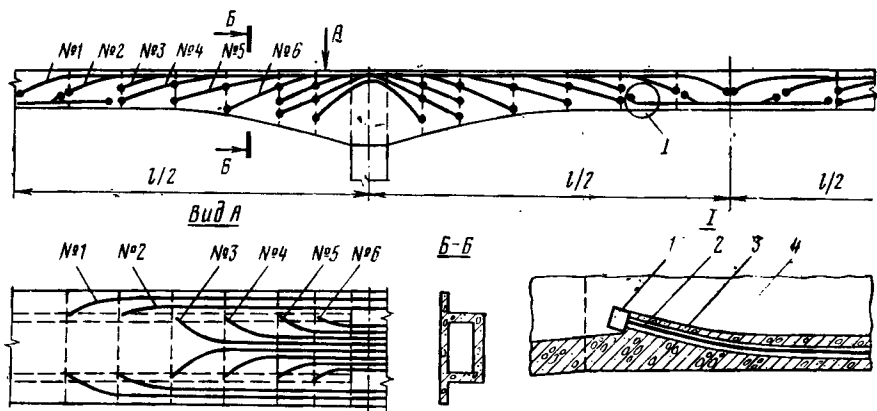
Армирование коробчатого пролетного строения при навесном бетонировании:
